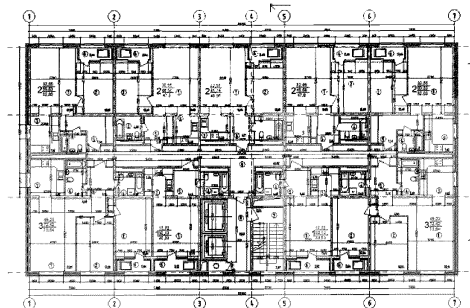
11-этажная блок-секция с широким шагом несущих конструкций. План типового этажа
